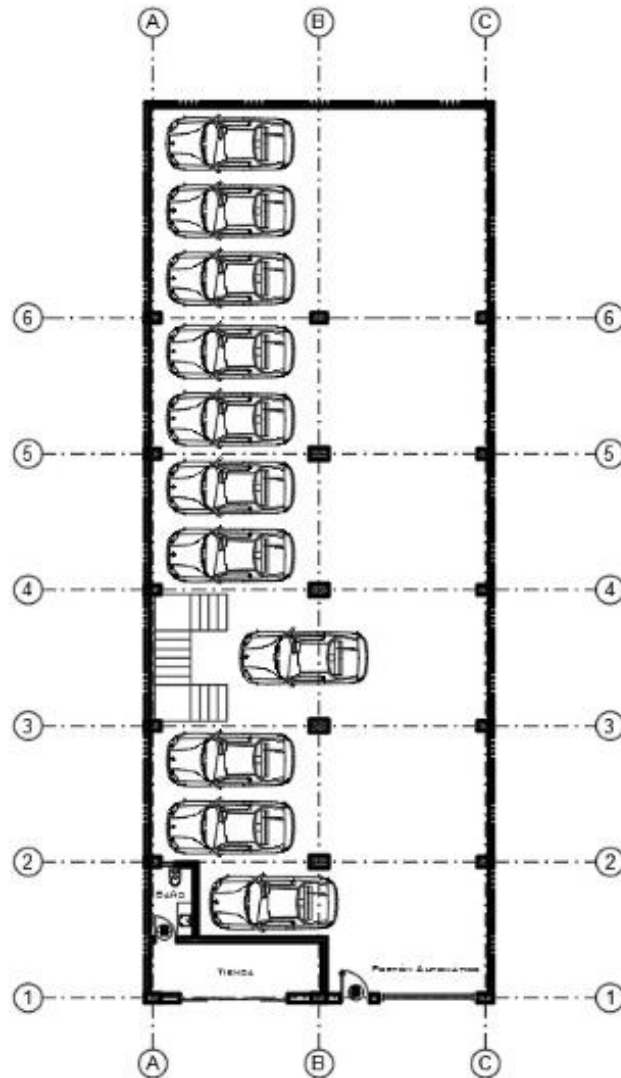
Plano en planta del proyecto constructivo (facilitado por nuestro cliente).
